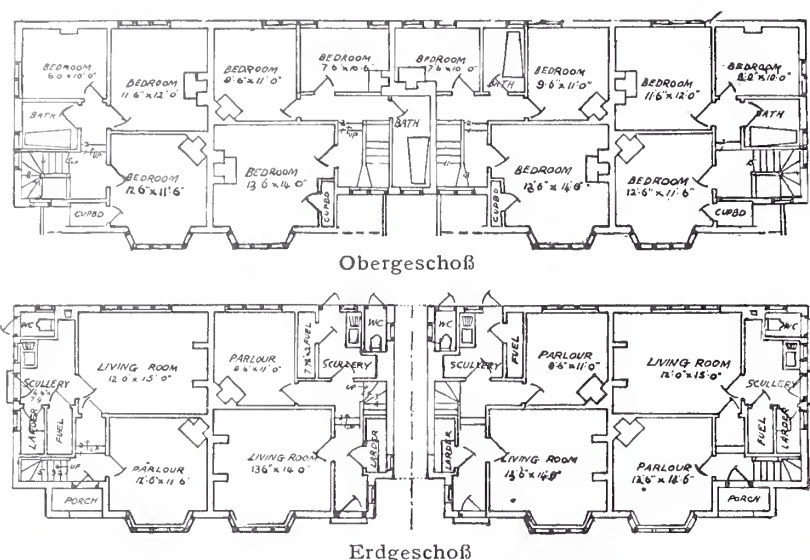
Garden Suburb Hampstead. Cottages in Willifield Way, Architekt: Michael Bunney, A. R. I. B. A. (Plan zu Abb. 16)
